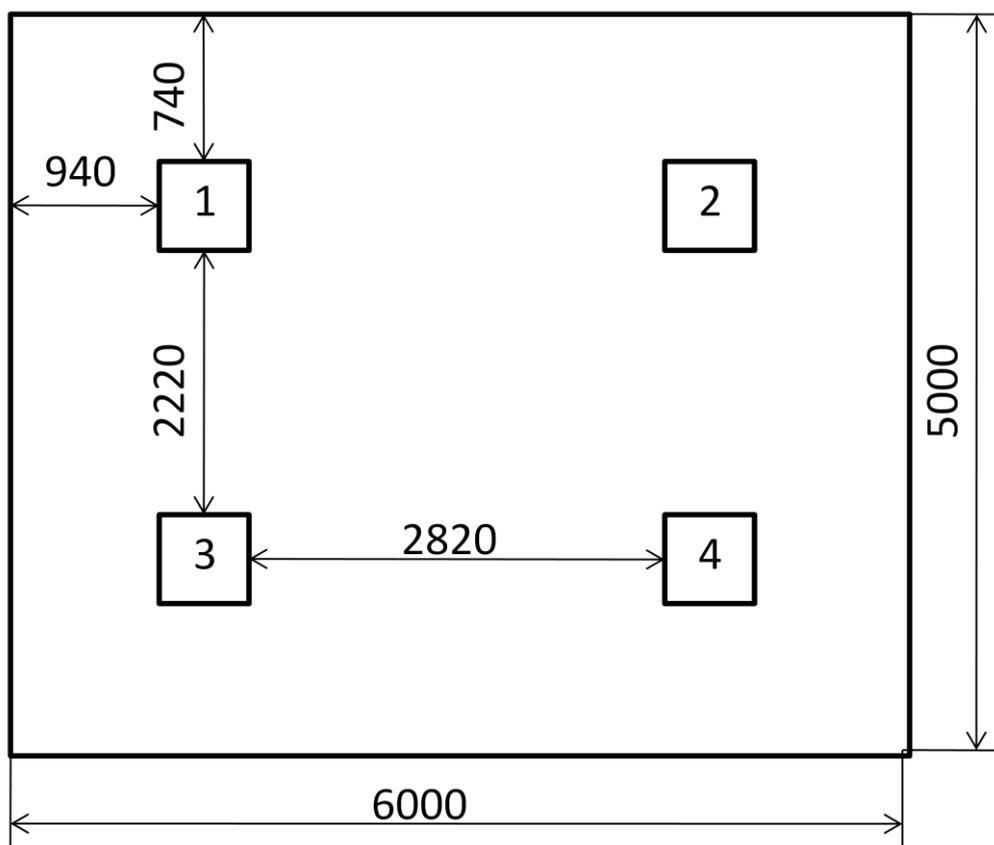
План помещения и размещения светильников с люминесцентными лампами.
